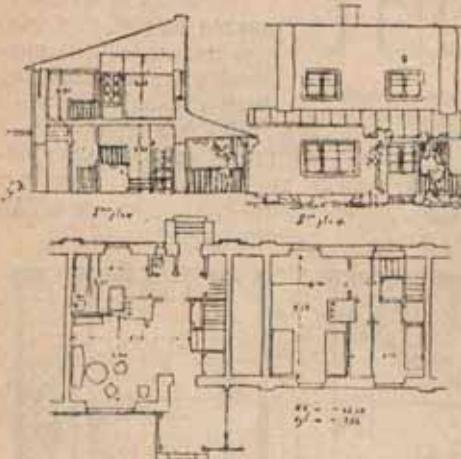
Проф. Н. Марковников. План и фасад блока на 6 квартир
